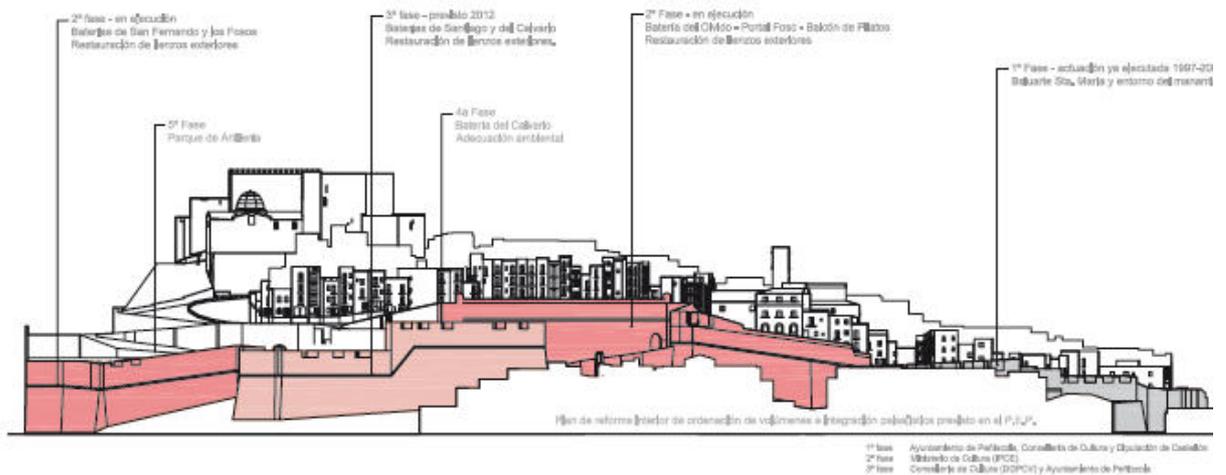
Fases de restauración de la fortificación renacentista ejecutadas o previstas en el Plan Especial de Protección
